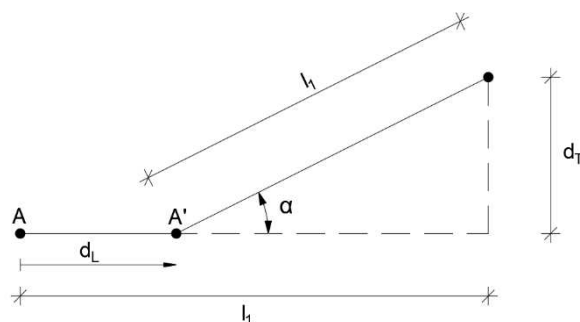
Esquema em planta do troço de cabos sujeito a um deslocamento transversal.
